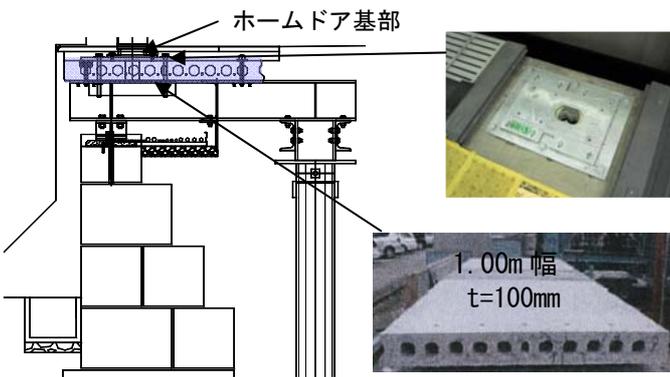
盛土式ホームの断面 写真-1 補強鋼板と穴あき PC 板
